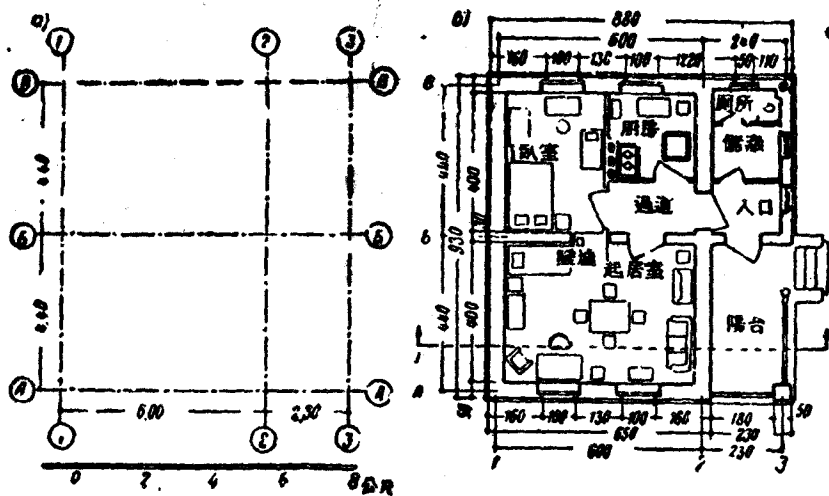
房屋主要軸線平面圖和平面圖內尺寸的標明方法。
